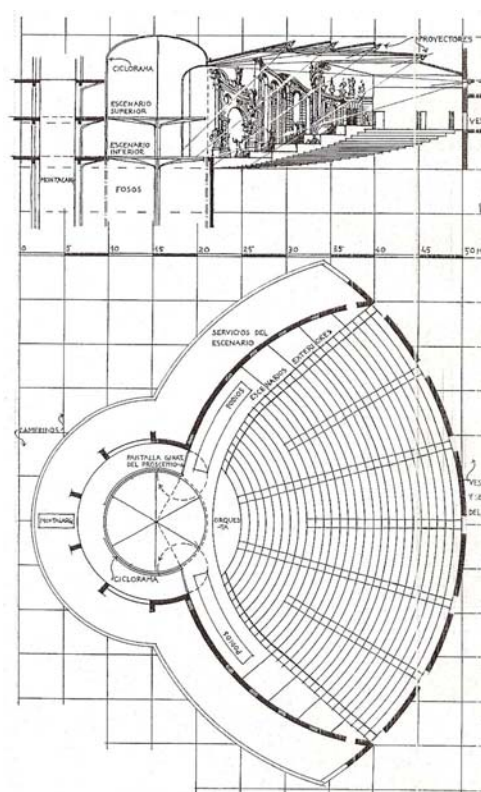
Secção e planta do teatro Beatrice y Jack de Leon (1947)
